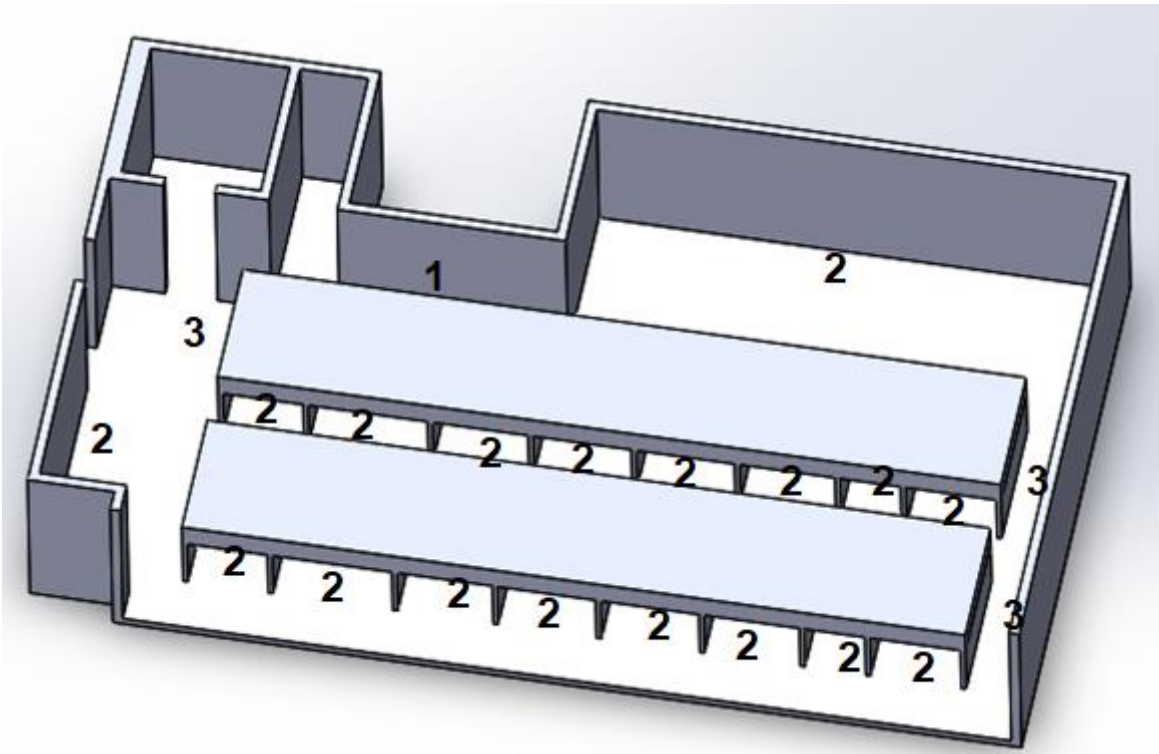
la planta de corte de la empresa Creaciones Henar LTDA
